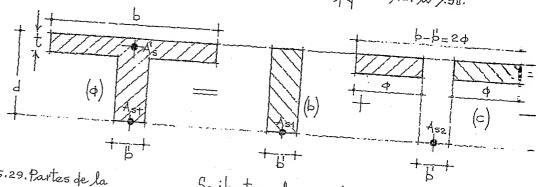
Partes de la loso trobajando, en\_ conjunto con la viga "t,"(c).
